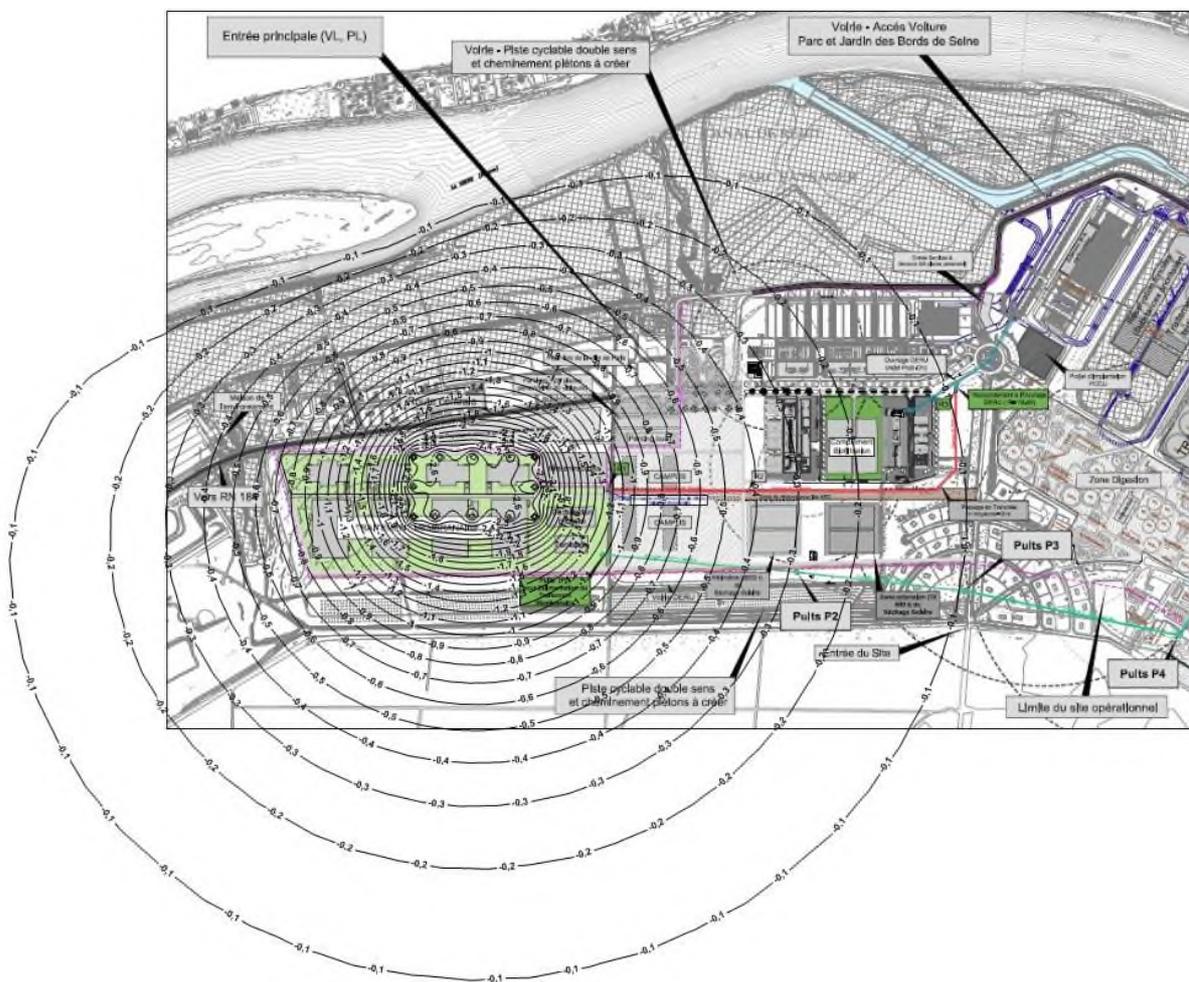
Modélisation du rabattement de nappe à l'objectif 18.5m NGF projeté sur le plan aérien du futur ouvrage.
